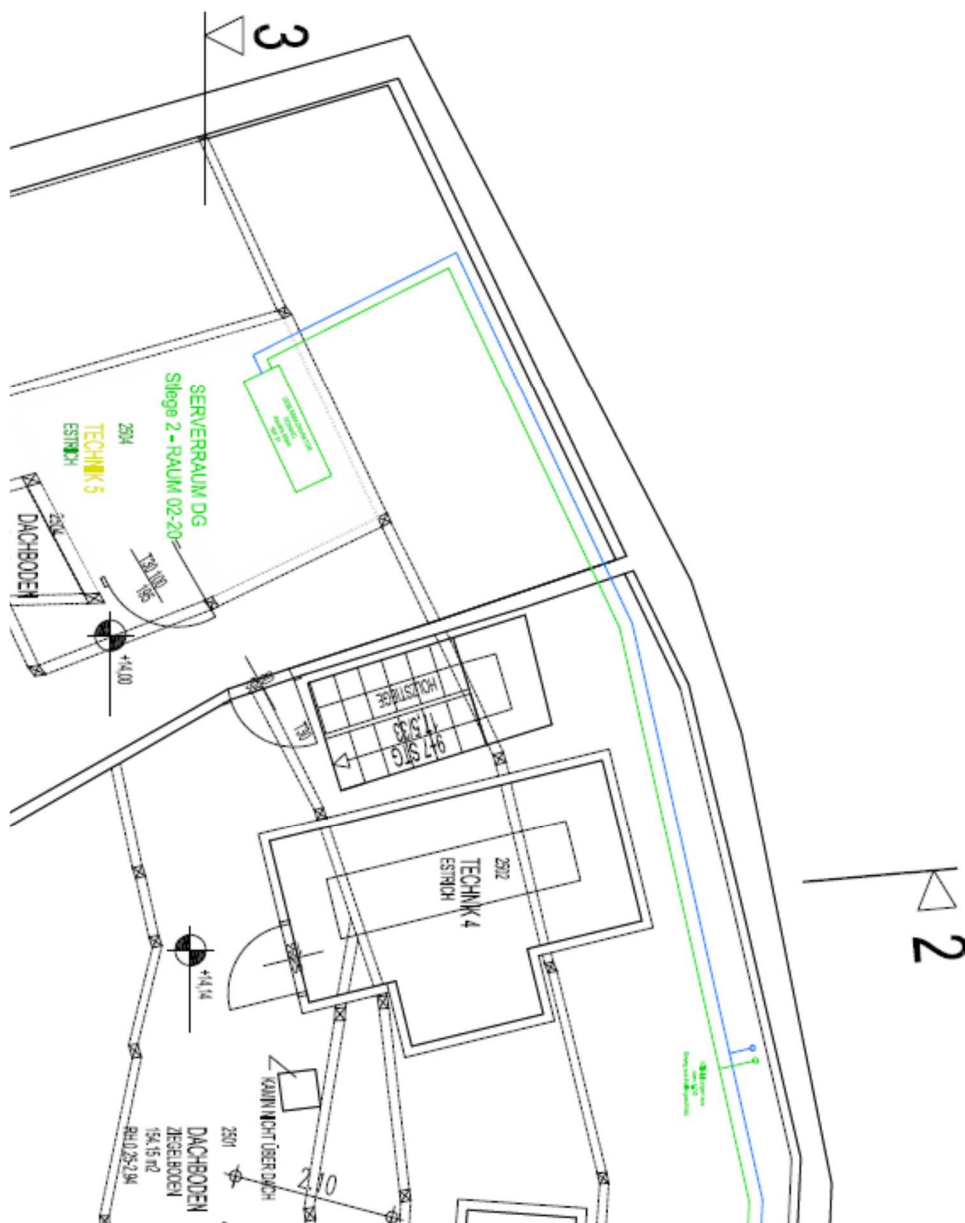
Grundrissausschnitt Dachgeschoss Serverraum 02-20
